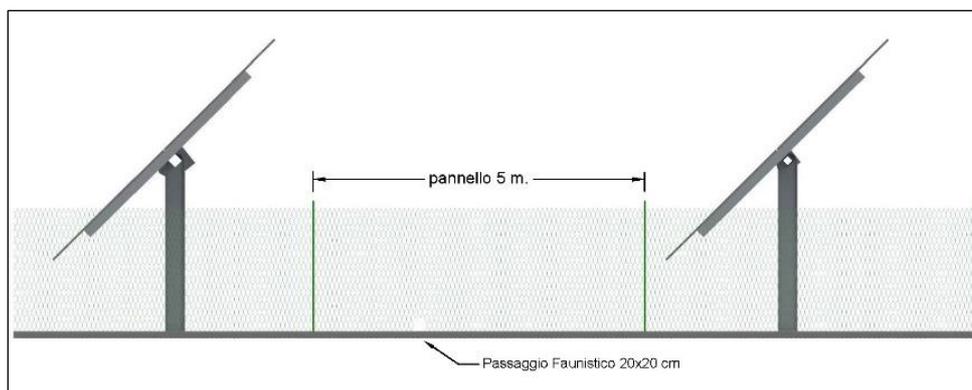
Prospetto recinzione perimetrale senza mitigazione
